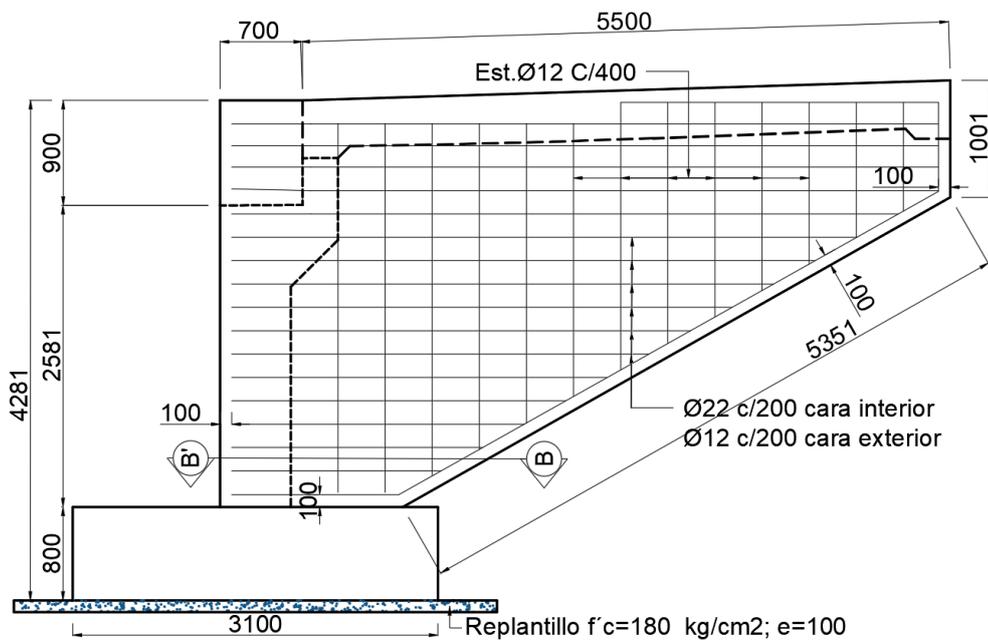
Armado de muro 2 [Elaboración propia]
